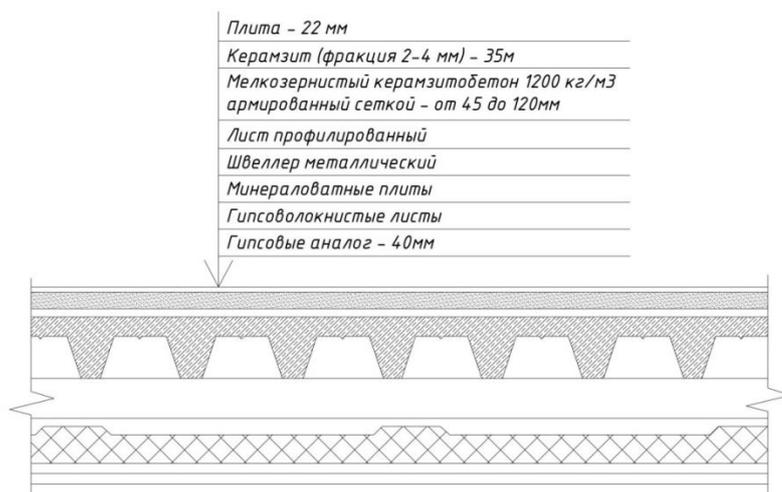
Междуэтажное перекрытие (узел выполнен на основе интернет-ресурса:)
